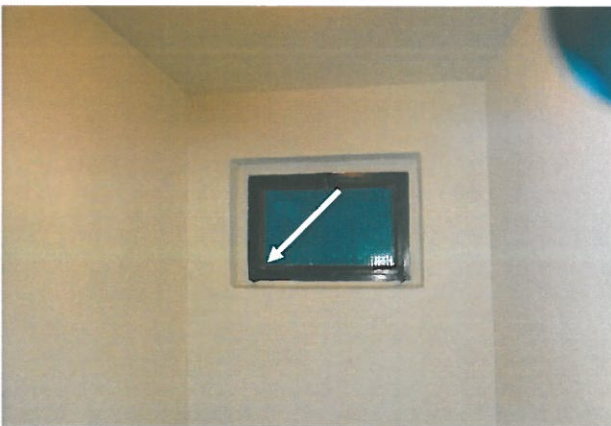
Pavillon 1: EG, WC, Kitt im Glasanschluss
